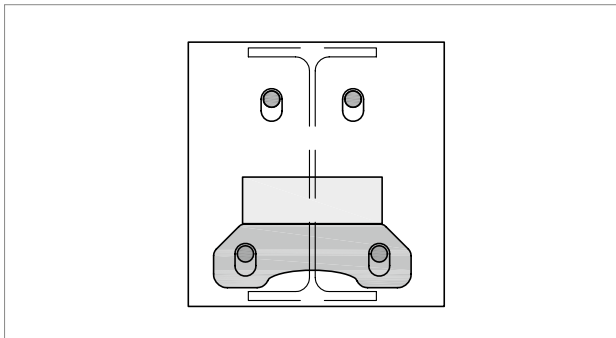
Schöck Isokorb® : liaison acier – béton armé ; le tasseau fourni par le client repose directement sur la plaque de reprise de charge
